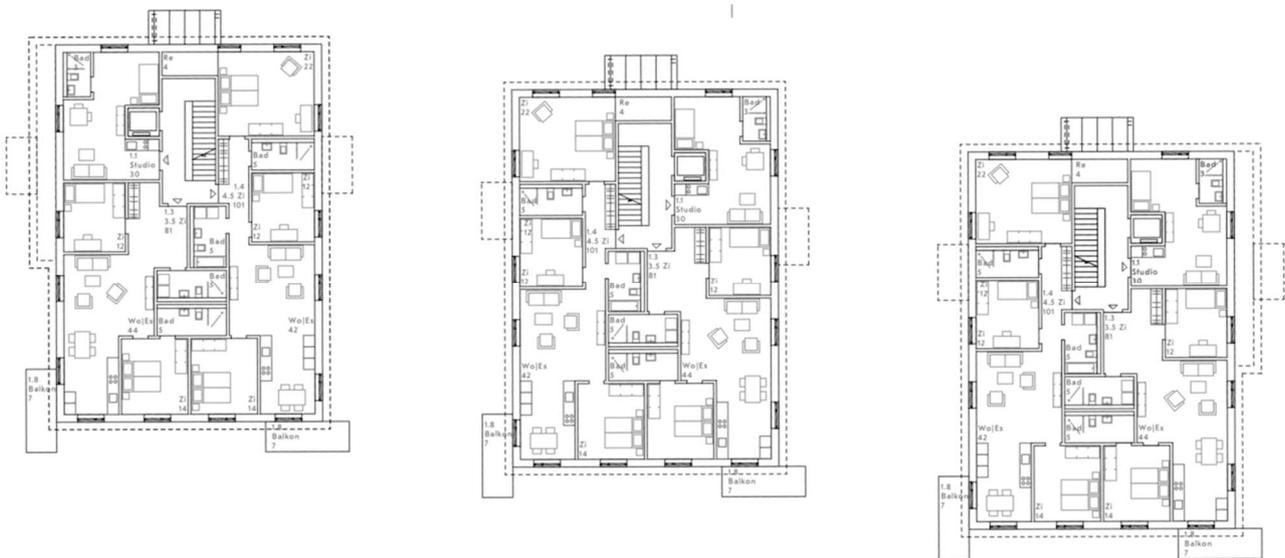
Grundriss Regelgeschoss (1. OG) DREI RÖSLI (massstabslos)
